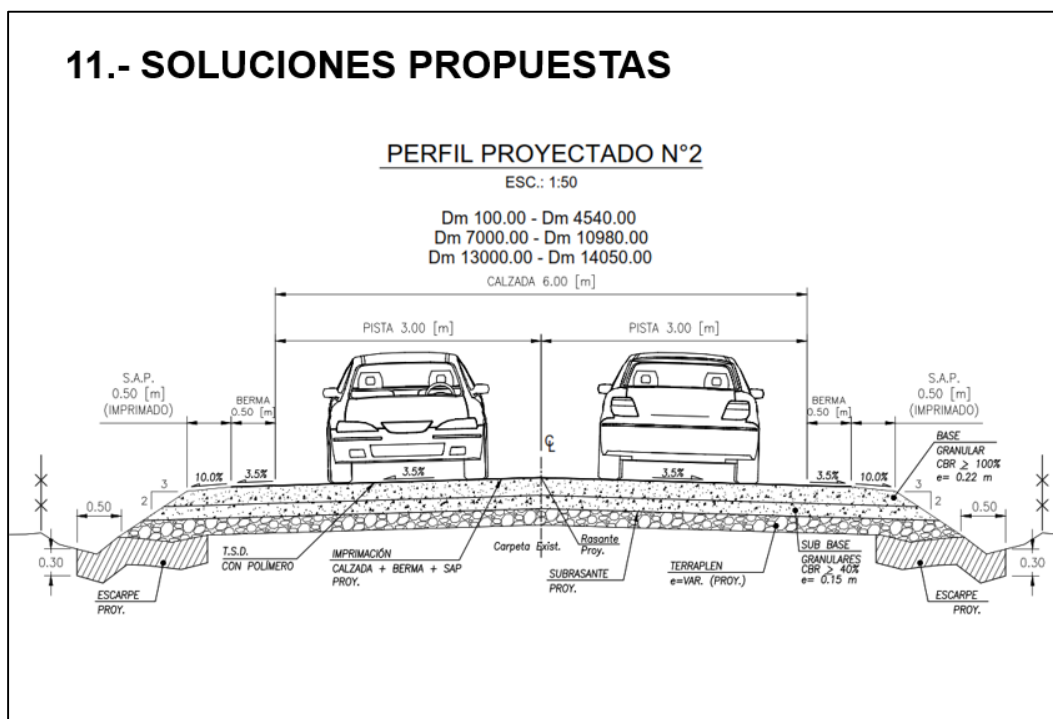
Plano Perfil Projectado Proyecto, N°2.
